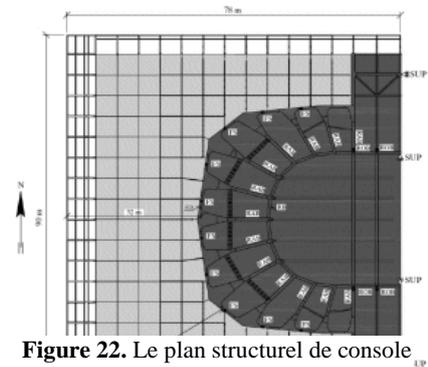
Le plan structurel de console (gris clair) et le toit supporté par le bâtiment (gris foncé)
